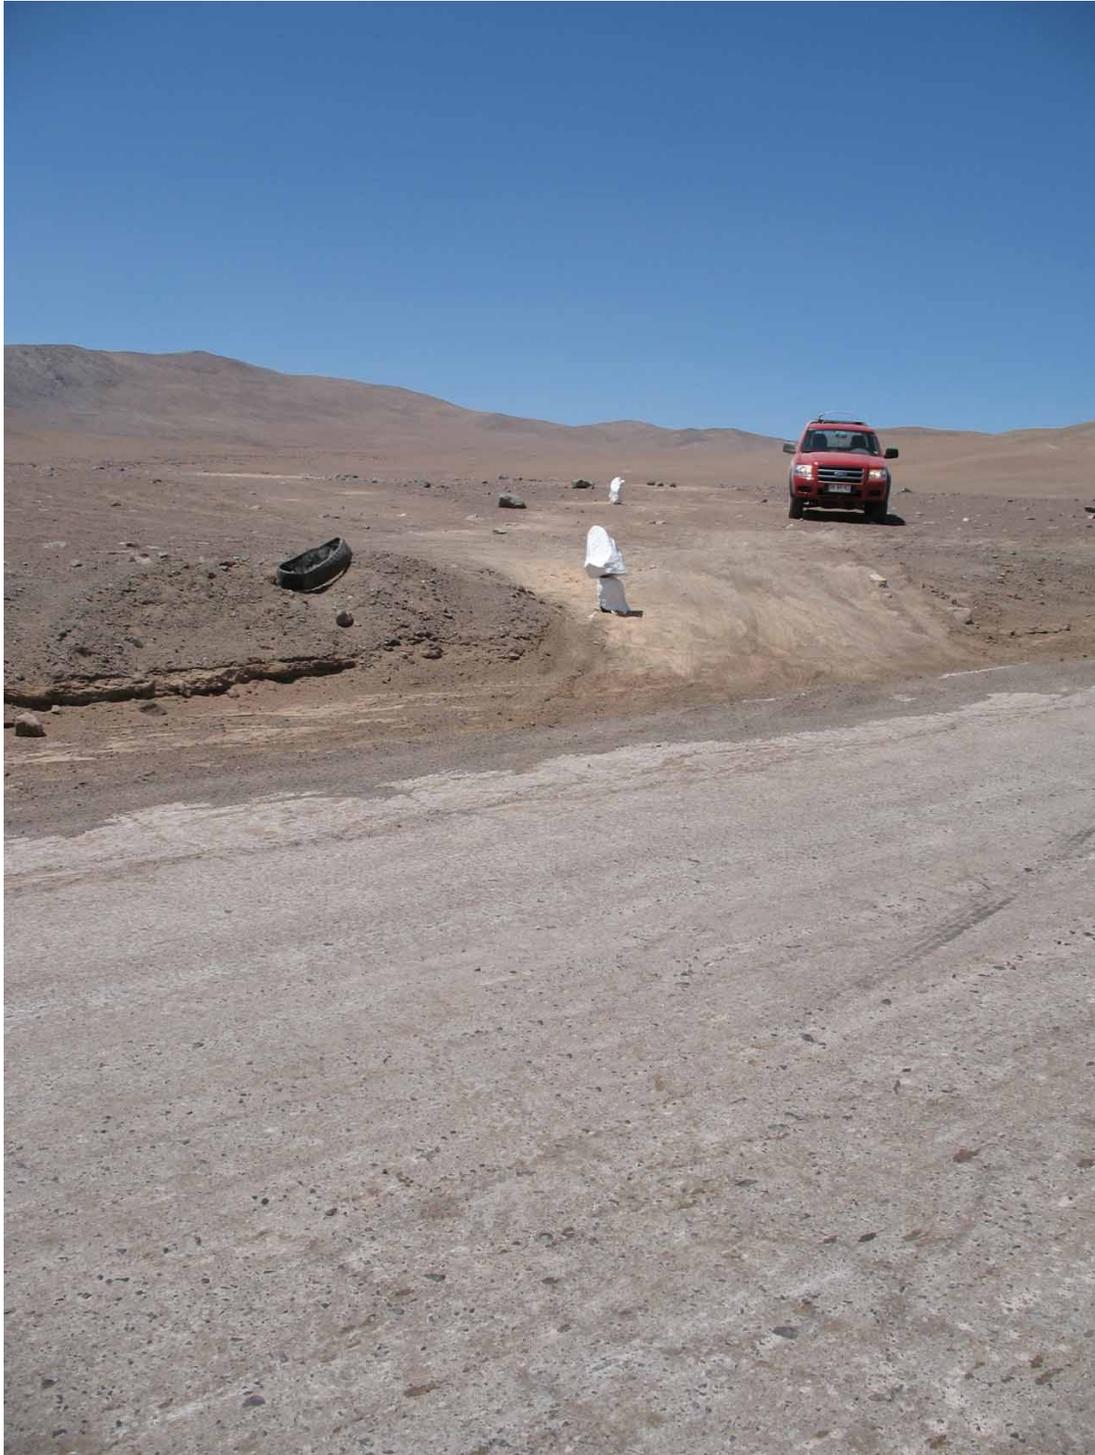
Empalme de Ruta B-710 con camino proyectado. Inicio de camino proyectado.
